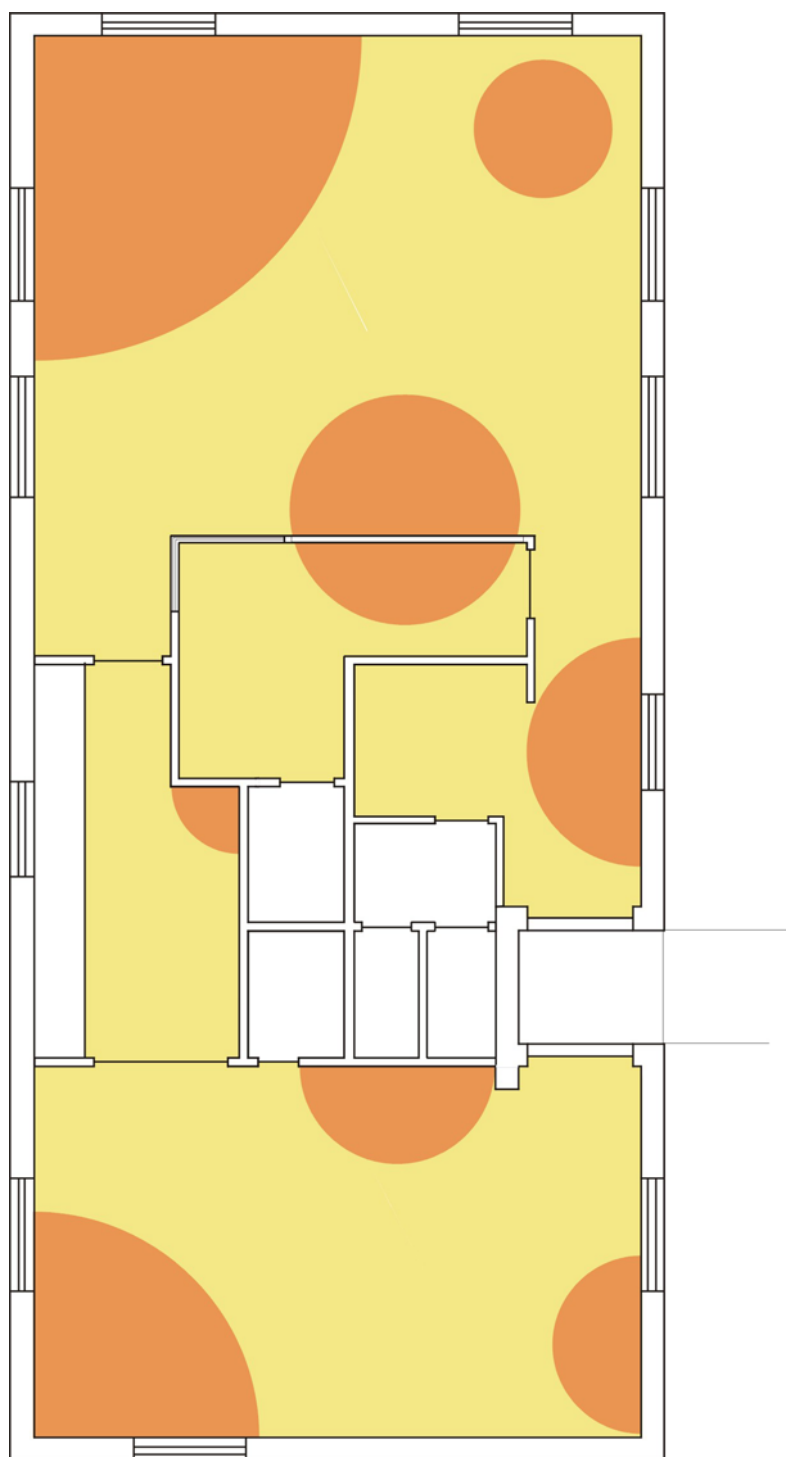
Estudo de propostas para aplicação de linóleo no pavimento
